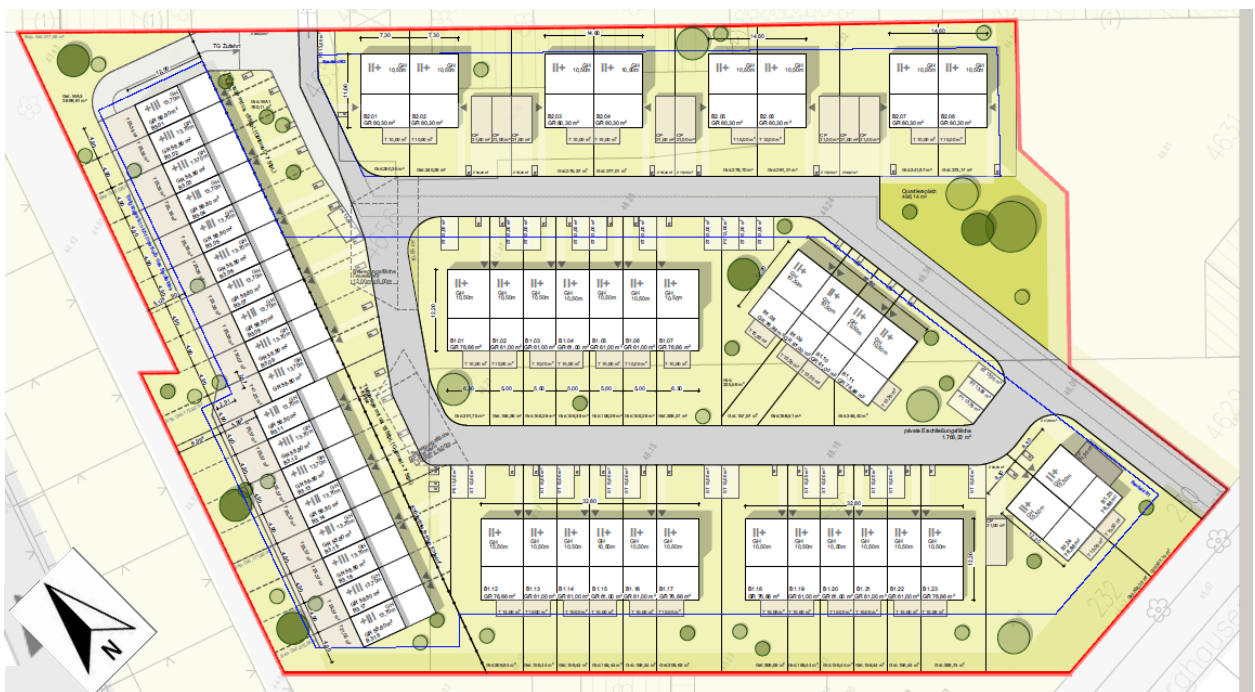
Lageplan des städtebaulichen Konzepts (a)
